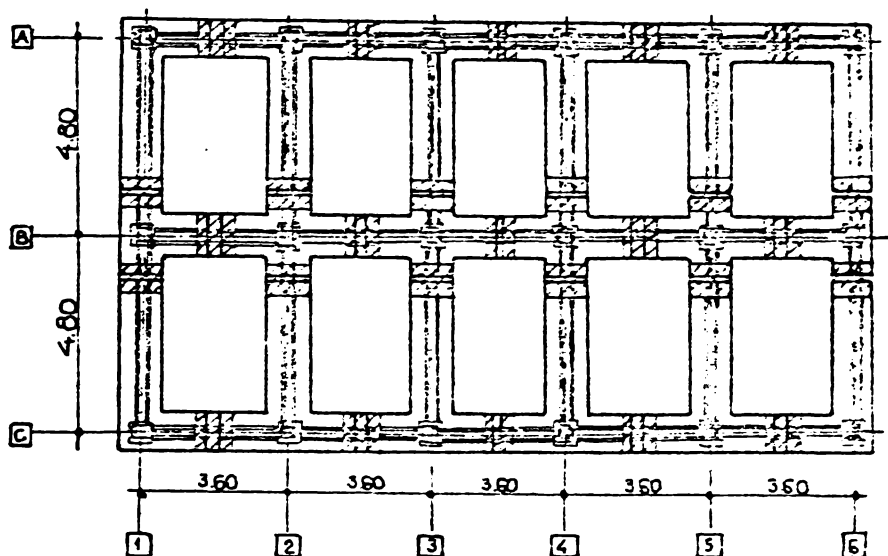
Planul de montaj al elementelor prefabricate pentru tălpi
